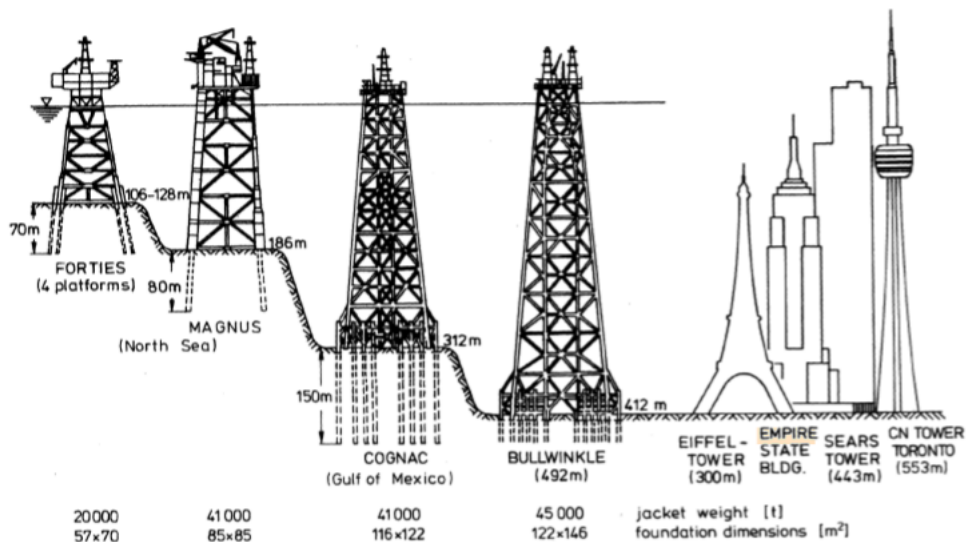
Estruturas offshore metálicas fixas em águas profundas [5].
